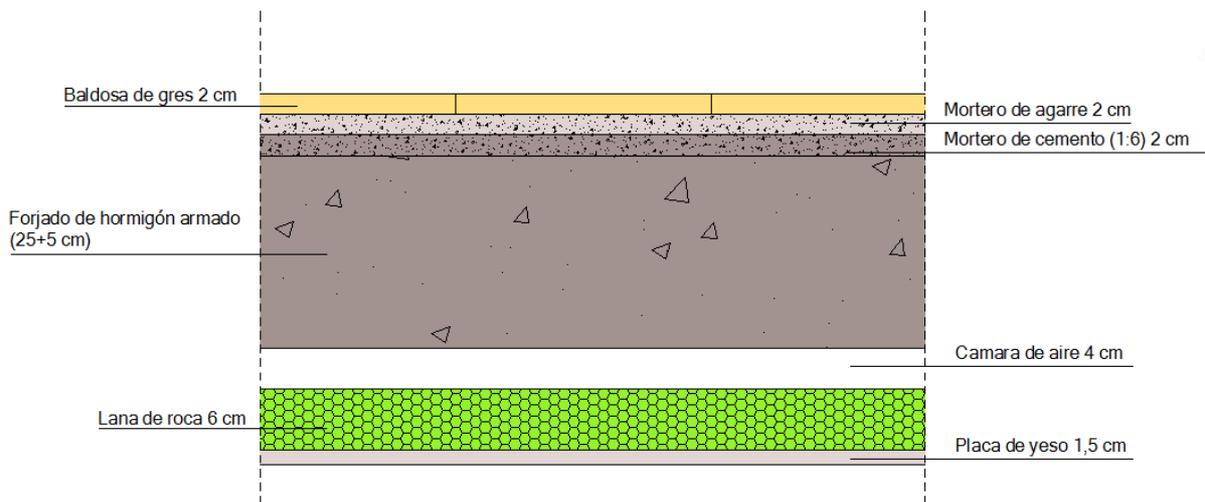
Detalle forjado planta baja propuesto.2014. CAD.
